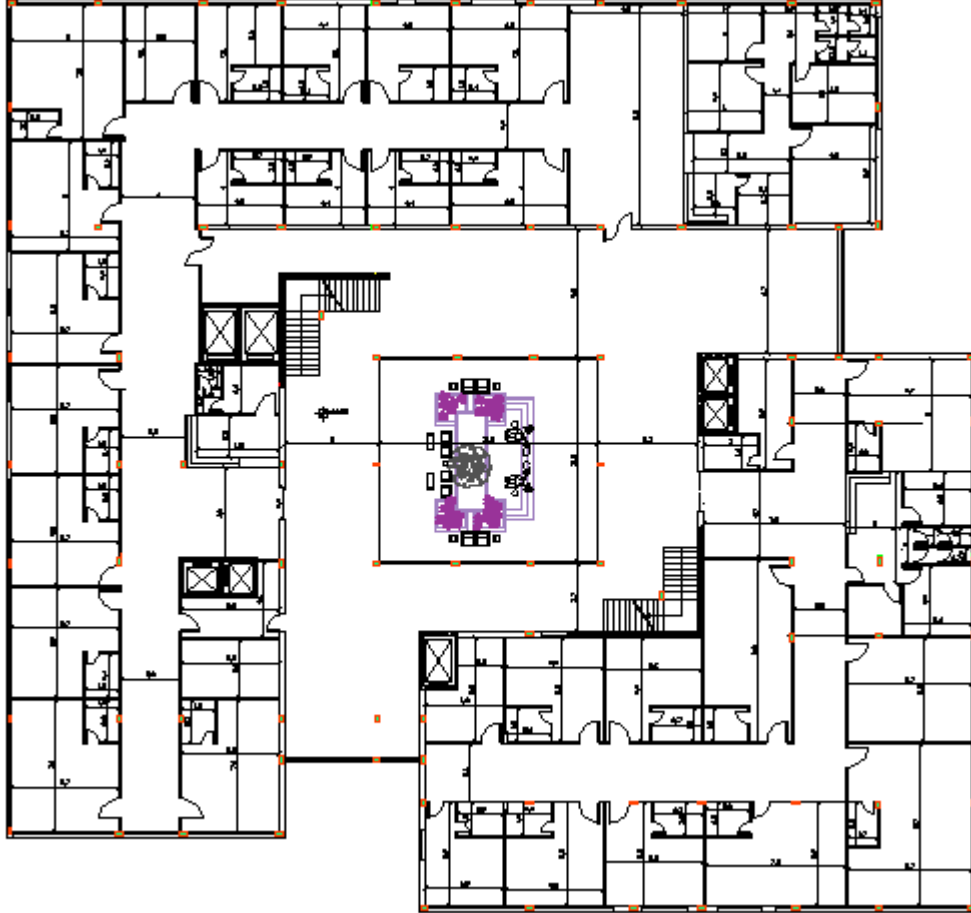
المسقط الأفقي للطابق الثاني.
